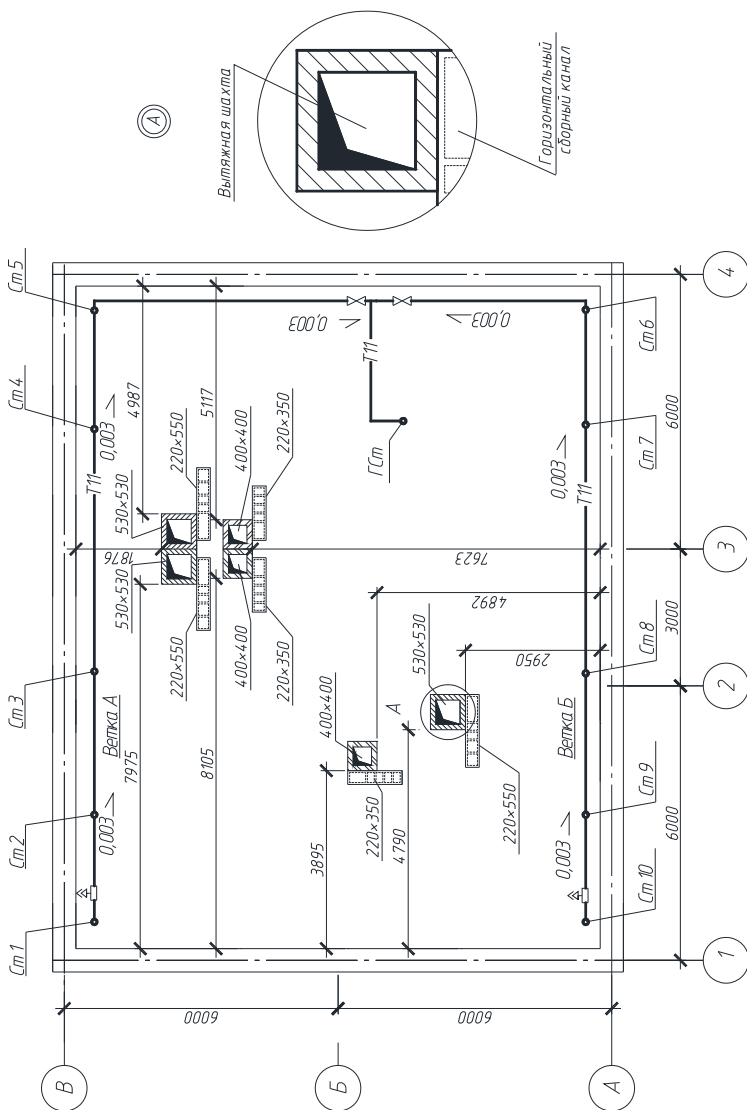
План чердака с приставными шлакобетонными вентиляционными каналами и верхней разводкой трубопроводов
